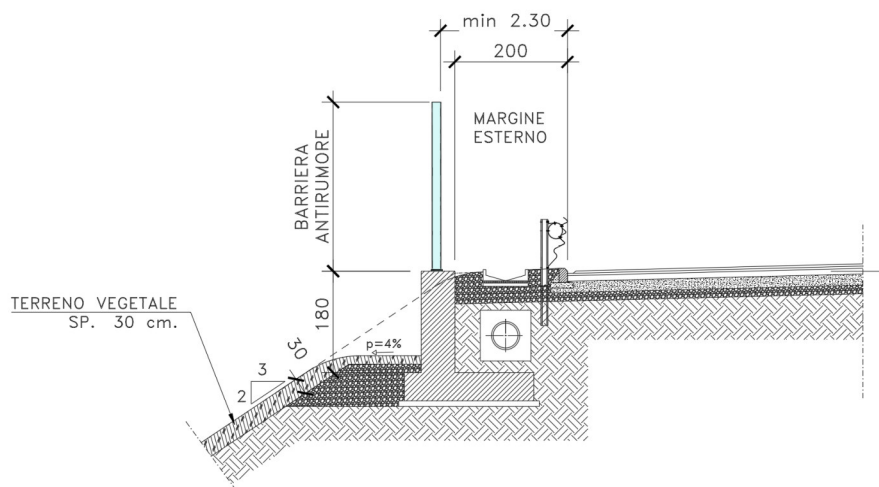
Sezione trasversale strutture di mitigazione acustica e opere di fondazione.
